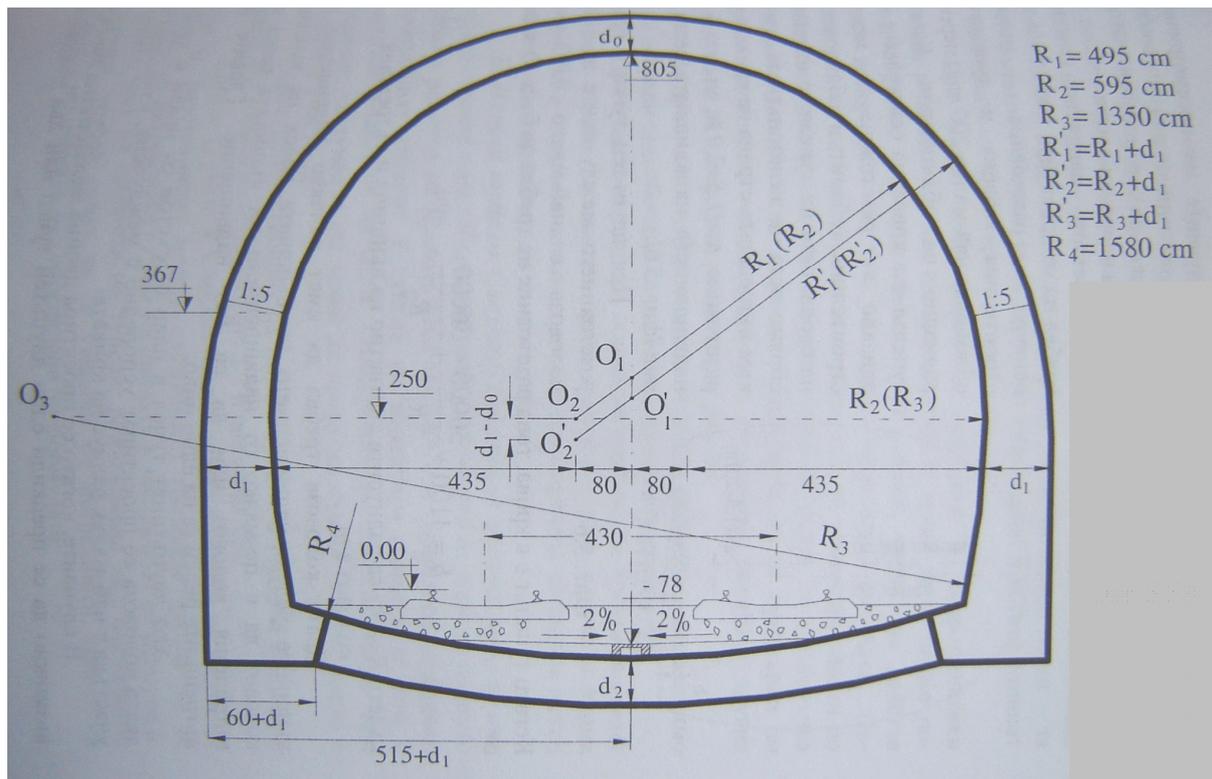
Typenprofil für zweispurigen Eisenbahntunnel
